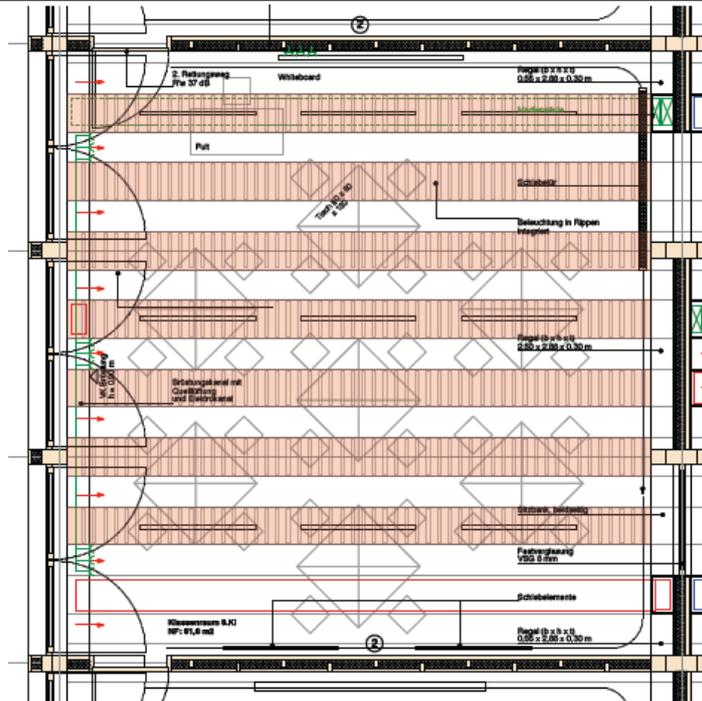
Grundriss Klassenzimmer, Deckenabsorber (rot markiert)
